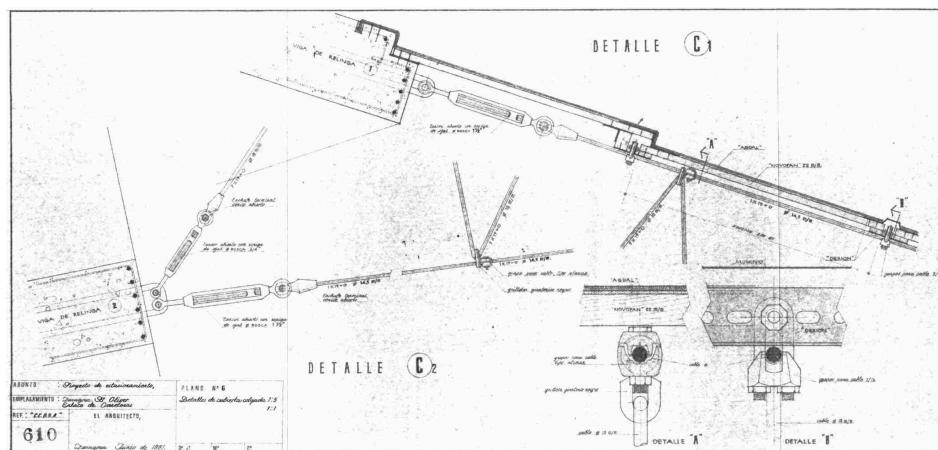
Detalle constructivo cubierta tensada y acabado, Estación de los Enlaces, Zaragoza
